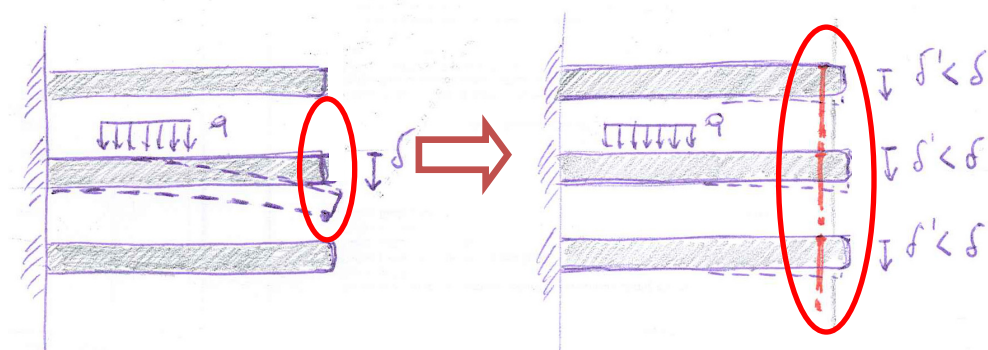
Modifica dello schema statico delle lastre delle pedate: mensole collegate mutuamente.
